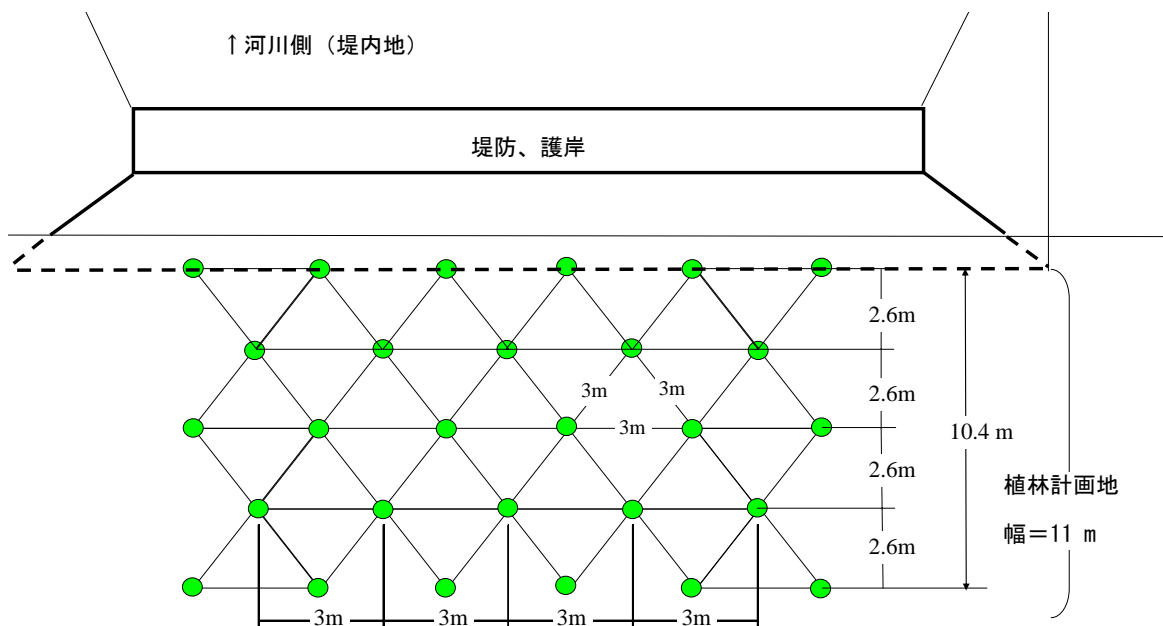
河川構造物沿いの植林計画標準配置図 (タイプ A)
